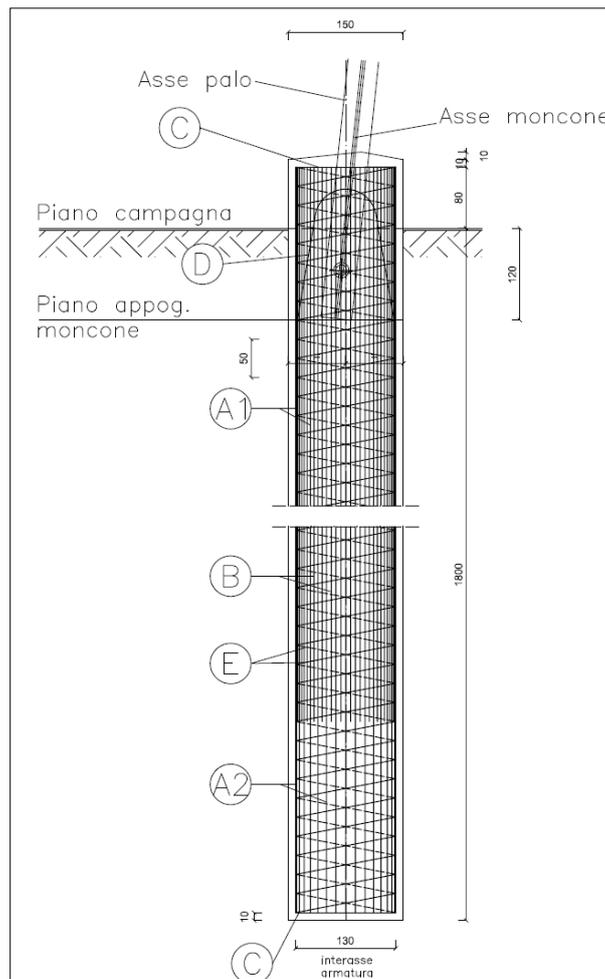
Schema tipo di fondazione profonda su pali trivellati per sostegni a traliccio.
